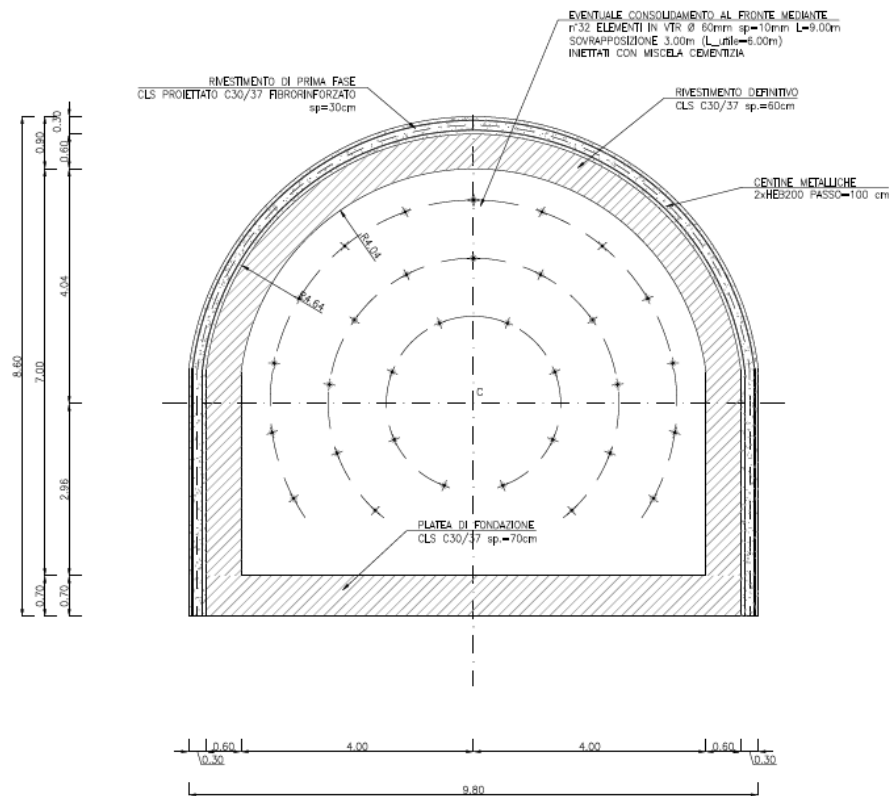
Sezione tipo P-Piez 3: geometria del cavo e interventi di sostegno
